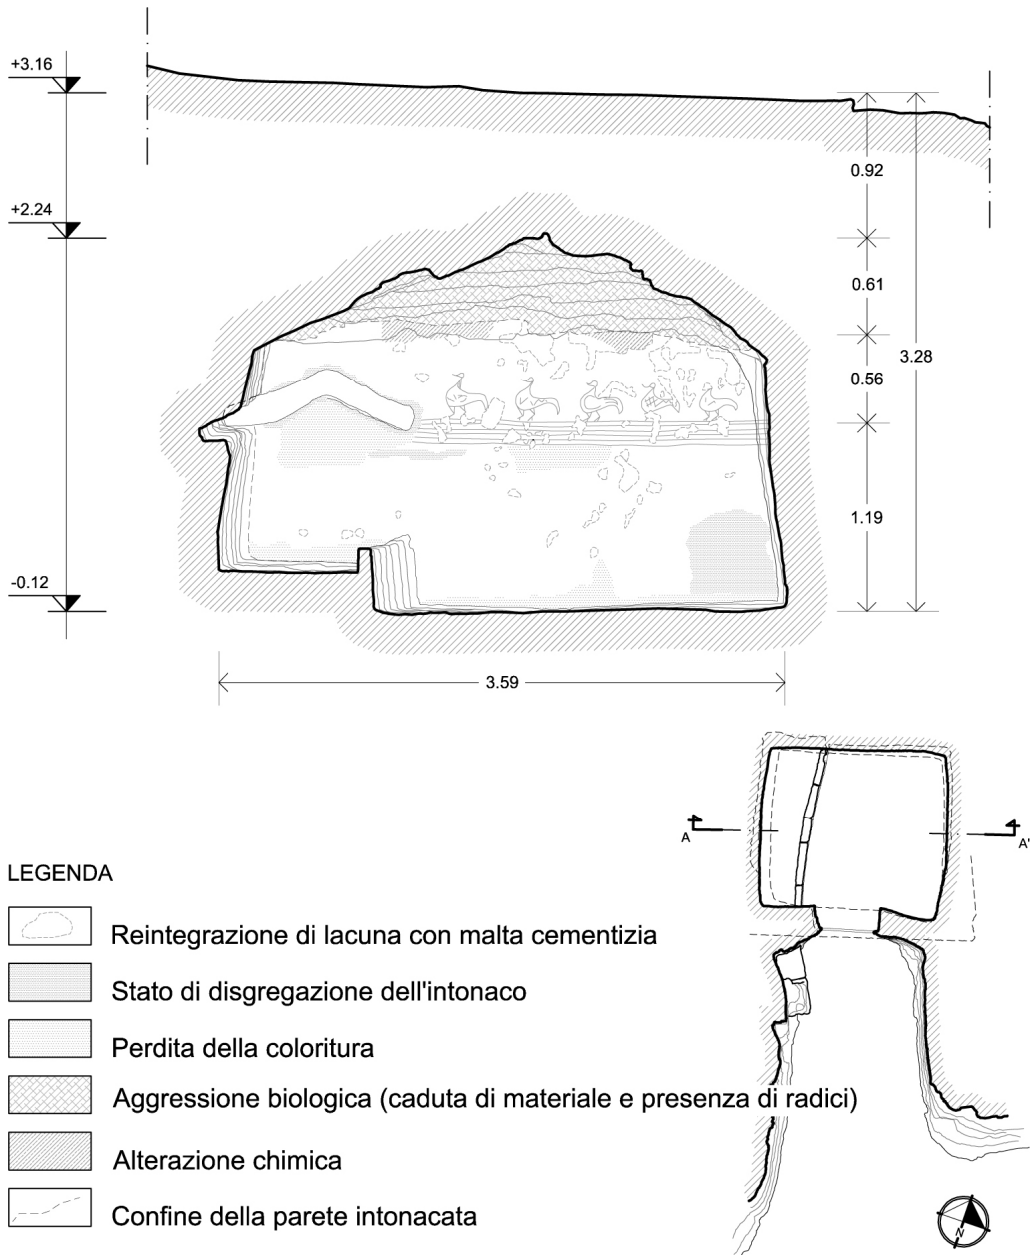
Tomba delle Anatre; sezione trasversale A-A'.
